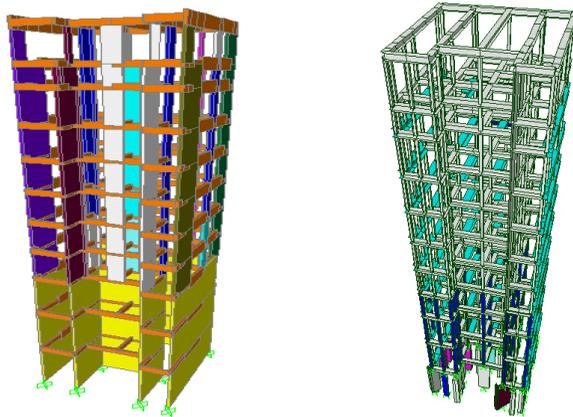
Gambar Denah Bumiminang Plaza Hotel
